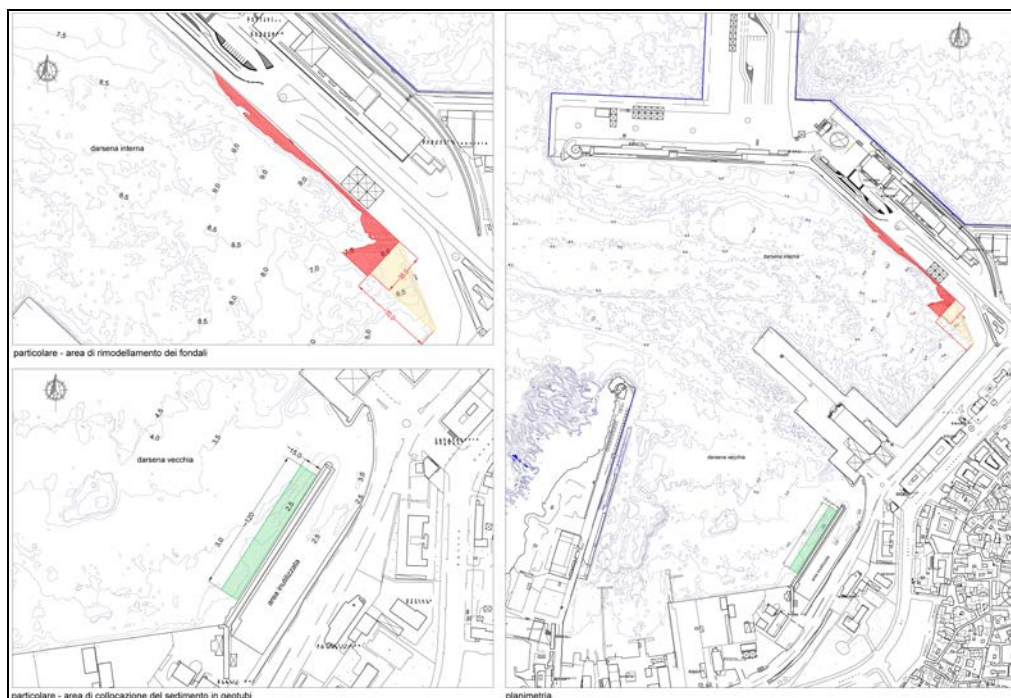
Stralci Elaborato 3.2 – Rimodellamento dei fondali – Spostamento dei sedimenti in ambito portuale – progetto definitivo
